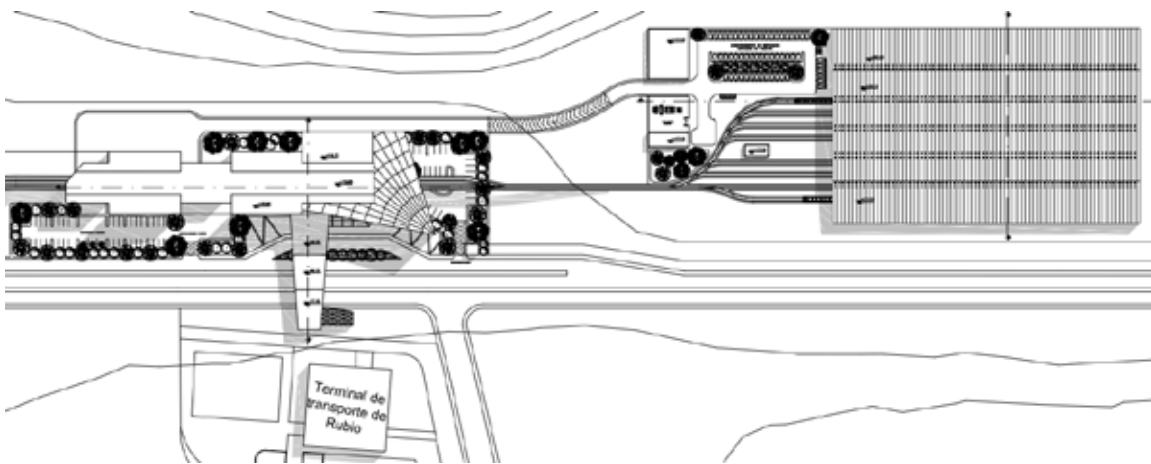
Planta Conjunto Propuesta Estación Terminal en la Ciudad de Rubio.
